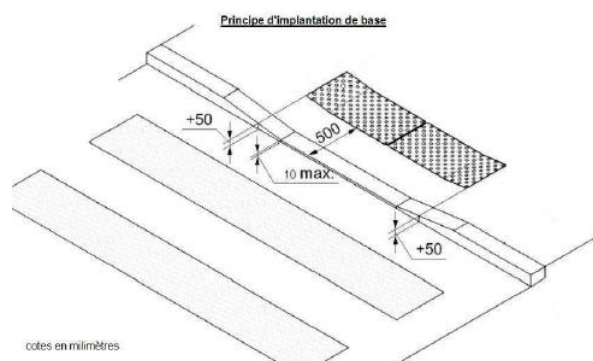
Pavimento tátil paralelo à passagem de peões
